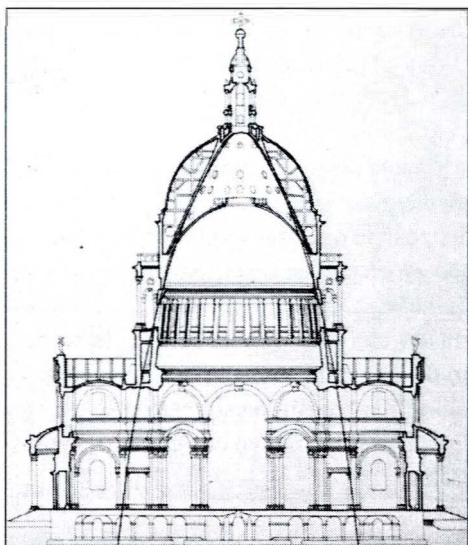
Sección de San Pablo con la posible curva centenaria superpuesta a la estructura
